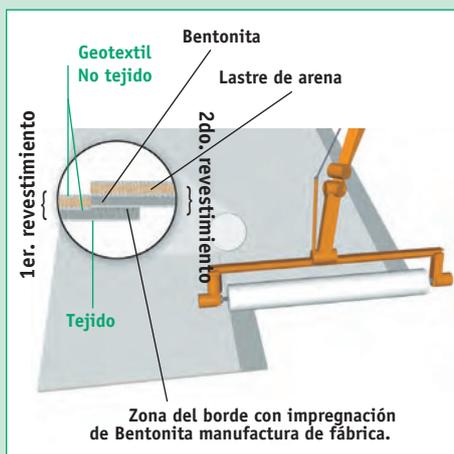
Vista esquemática de Bentofix® BZ 13-B traslapado.
